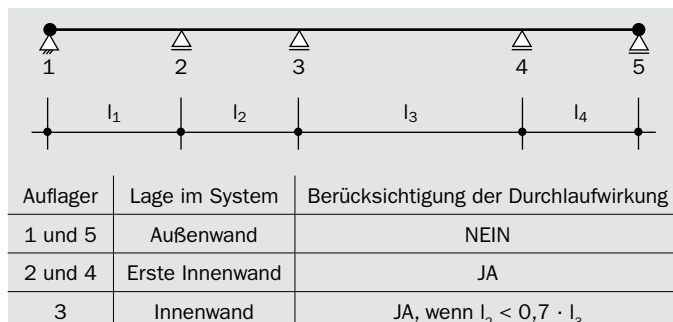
/1: Ermittlung der Deckenauflegerkräfte bei einachsigen gespannten Decken
